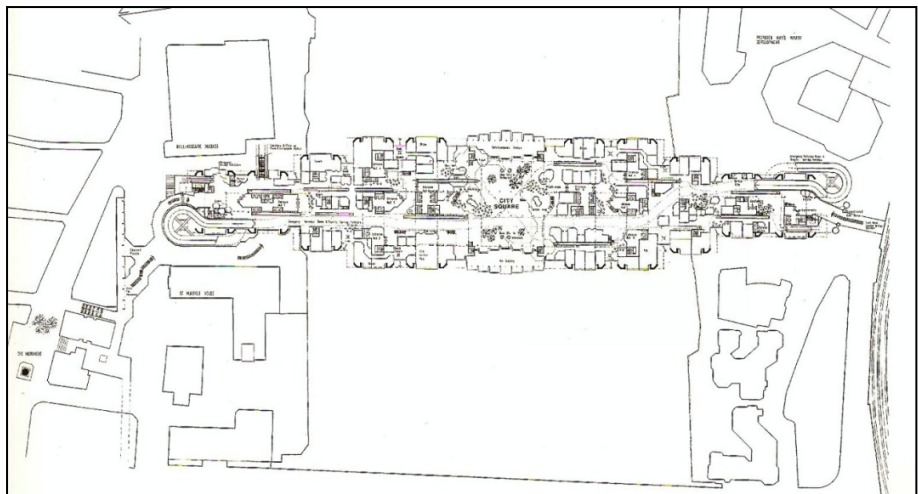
, R. Seifert and Partners, *City bridge: planta ao nível da praça, 1980.
